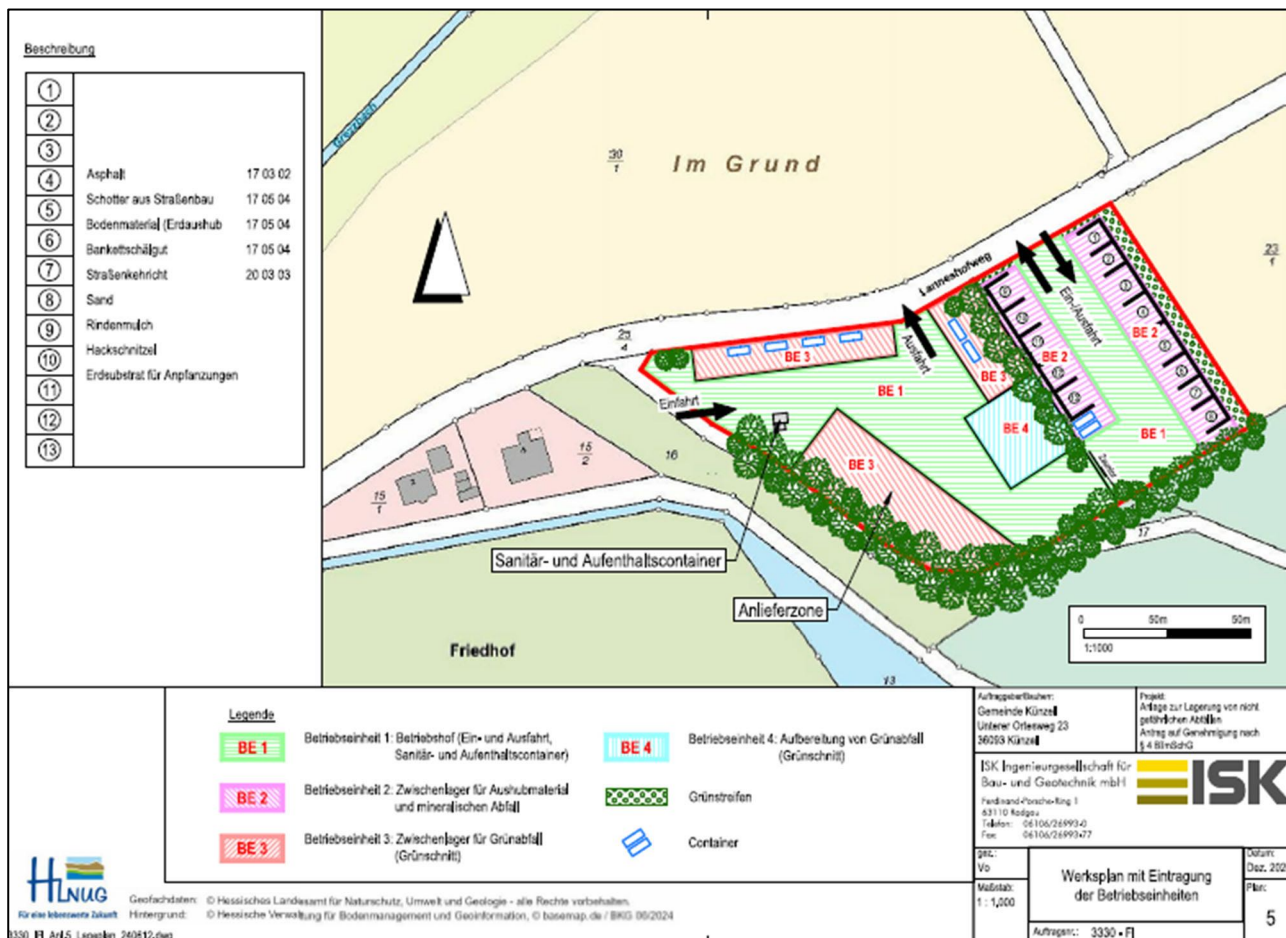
Lageplan zur „Anlage zur Lagerung von nicht gefährlichen Abfällen“ (Quelle: ISK, Dez. 2024)
